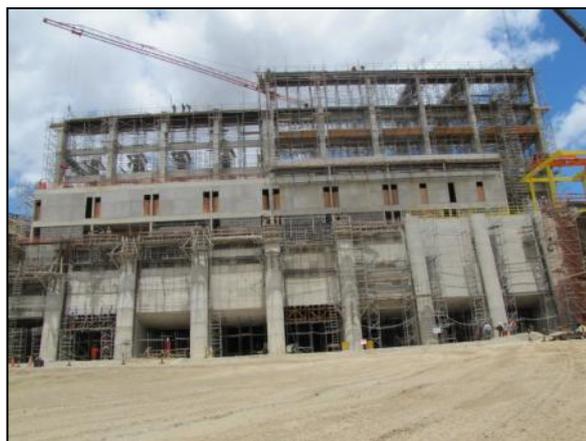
Estação de bombeamento EBI-3, Trecho I, Meta 1N, em Salgueiro - PE (fev/2014).
